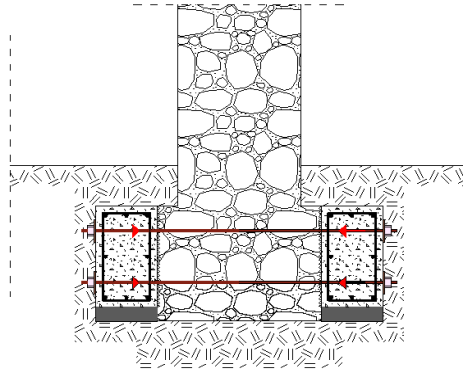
Refuerzo de zapata corrida 1. 2010. Rehabilitar con Acero
